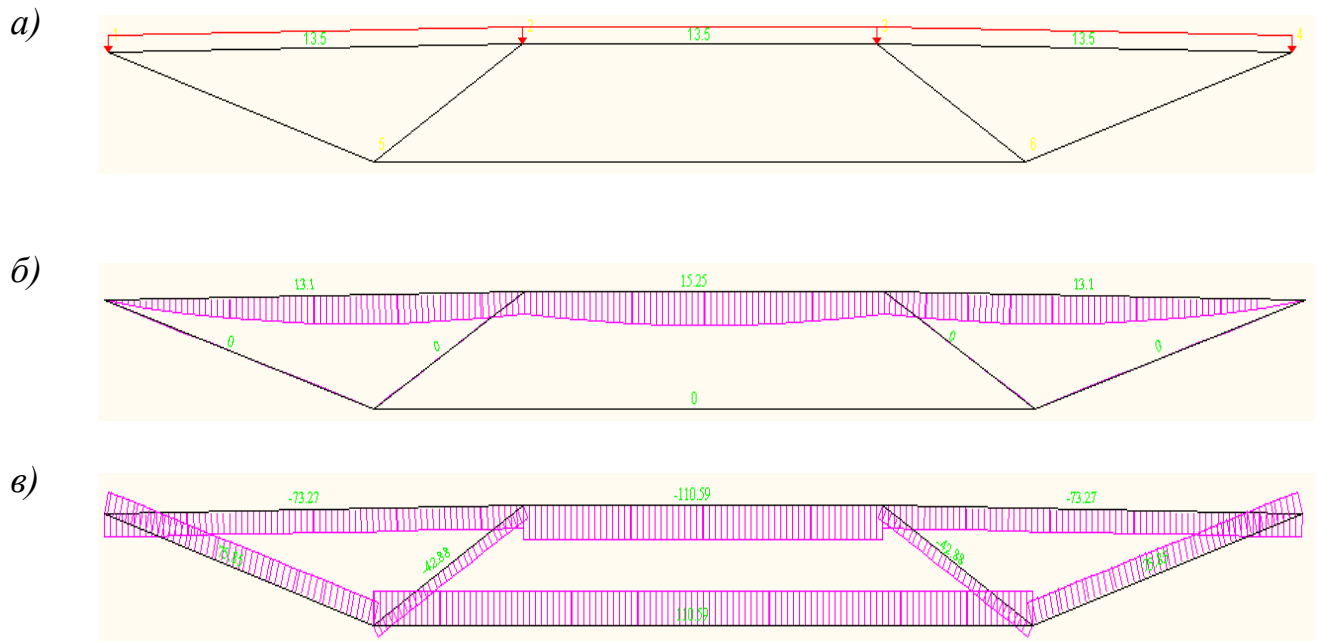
Навантаження від фундаментних блоків: а) – розрахункова схема; б) – епюра згинальних моментів; в) – епюра поздовжніх сил
